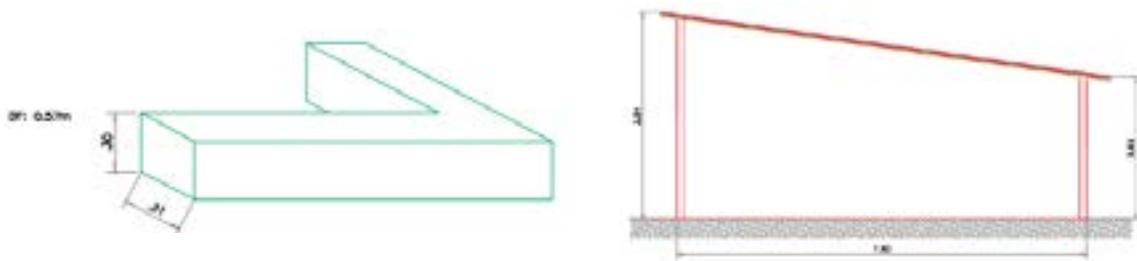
Detalle de cimentación y corte trasversal bloque 17
